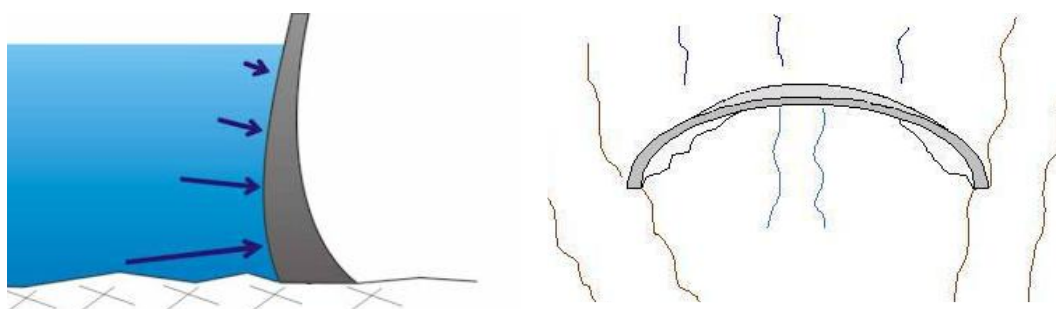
Barragem em arco. Perfil típico e vista em planta.
